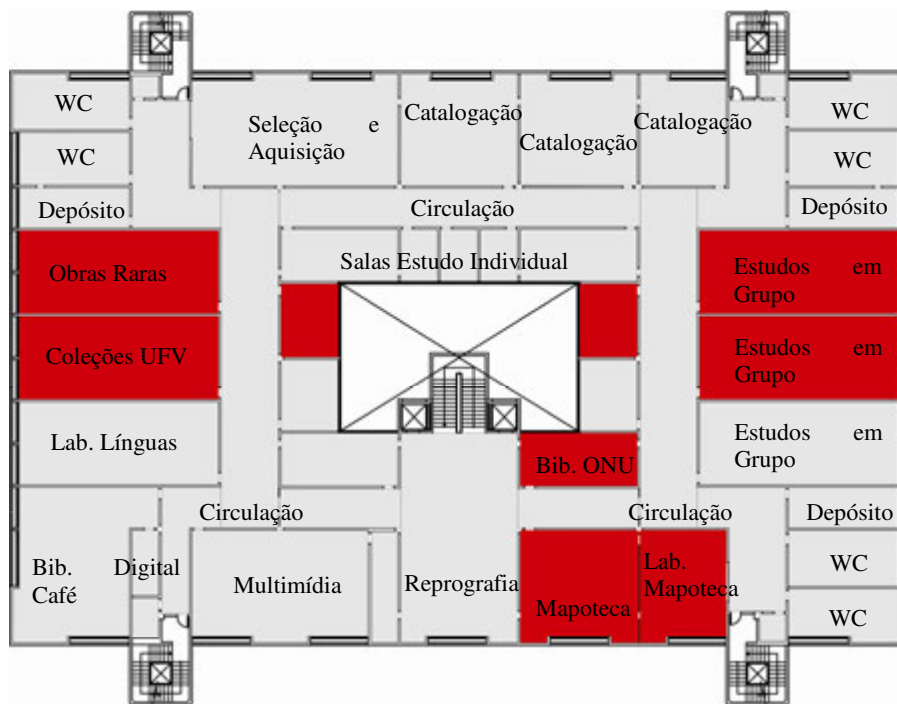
Planta baixa esquemática do primeiro pavimento.
